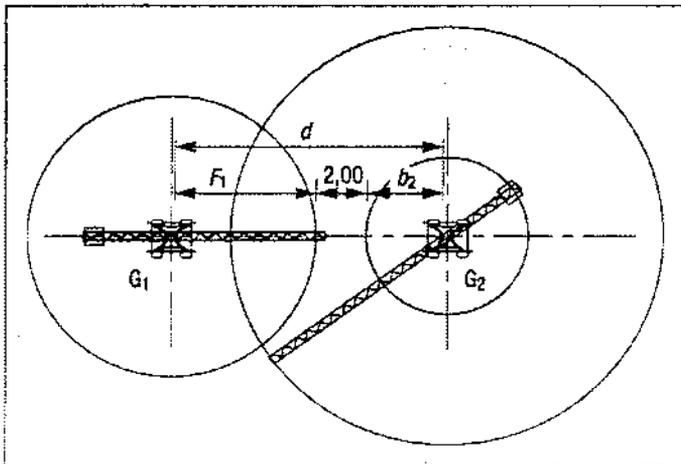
Conditions d'installation de grues dont les zones d'action sont sécantes.
